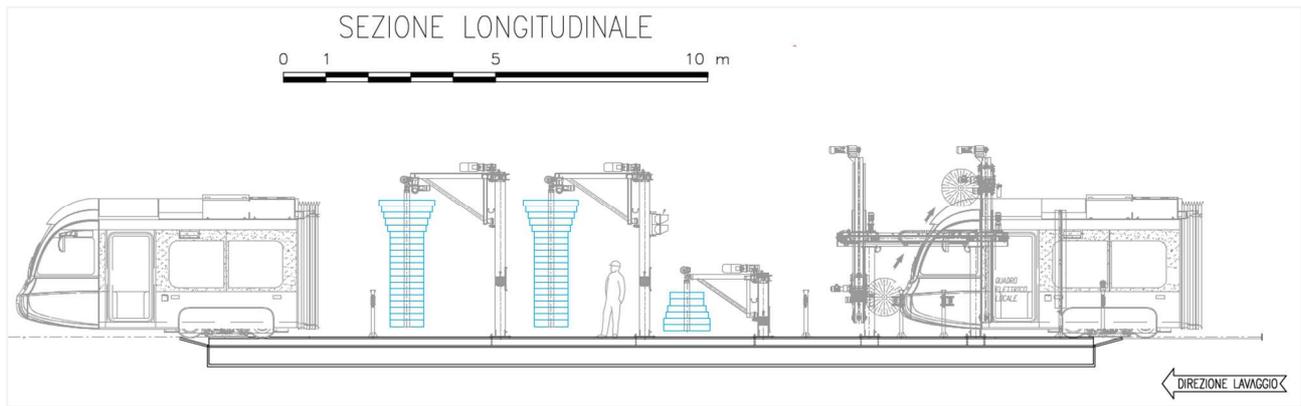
Sezione longitudinale impianto di lavaggio - dettaglio
